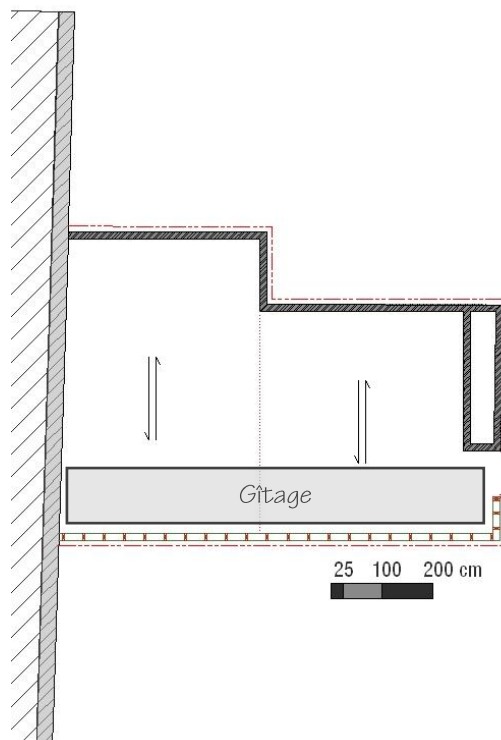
Plan de stabilité, haut espace technique (Source: Bureau JZH & Partners, 2010)
